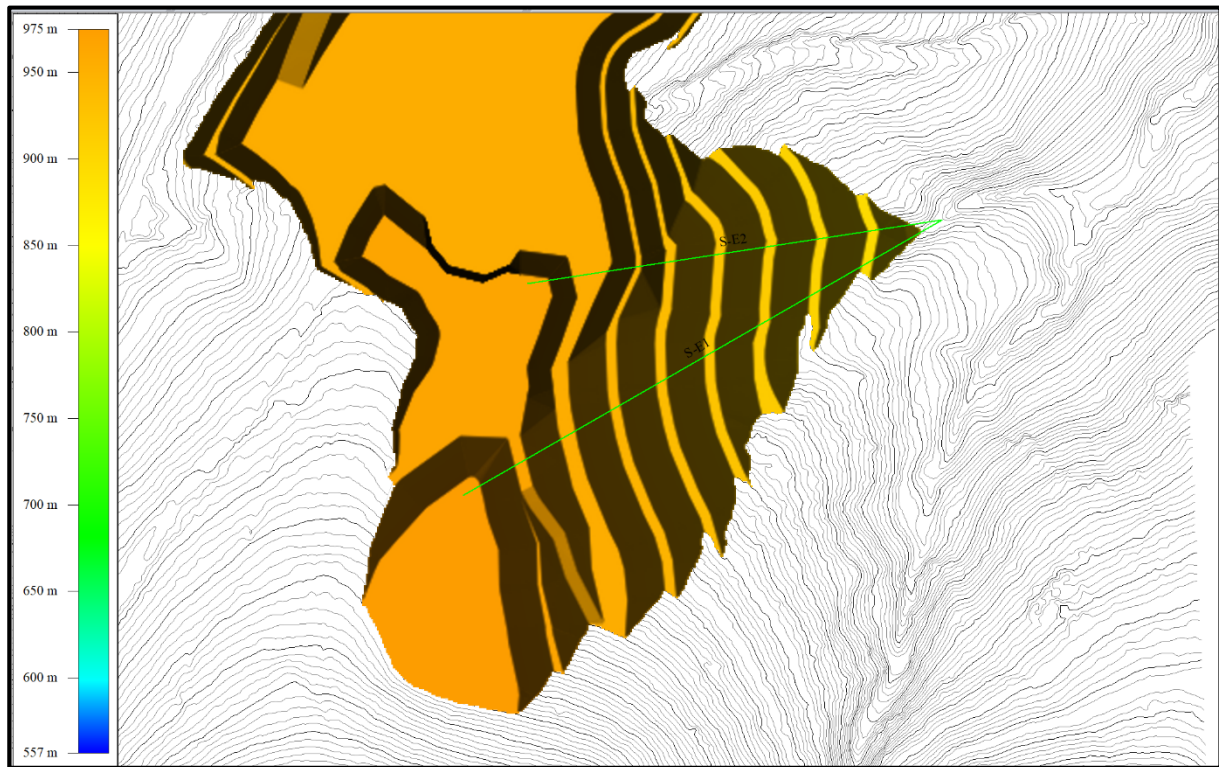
Localização das Seções transversais da Pilha E (E-1 e E-2).
